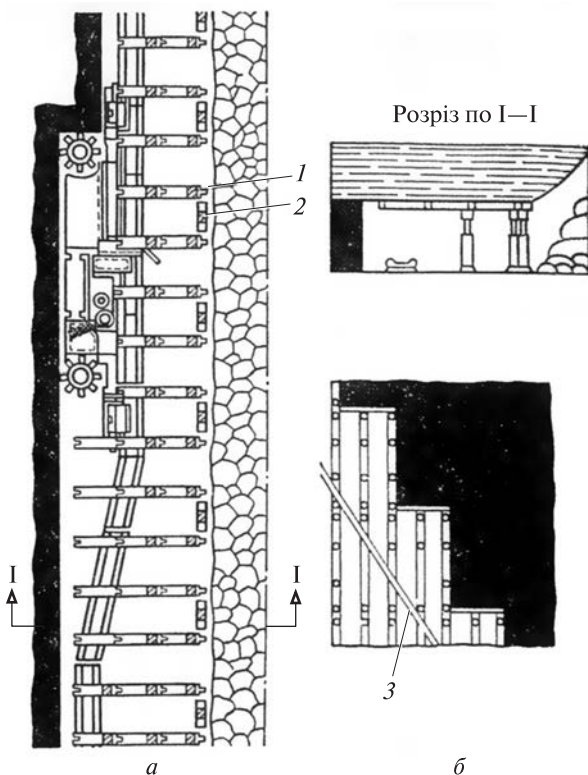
Індивідуальне кріплення очисного вибою (лави): *а* — на пологому пласті; *б* — на крутопадаючому пласті; 1 — металева стійка; 2 — металева посадкова стійка (тумба); 3 — вуглеспускний риштак
